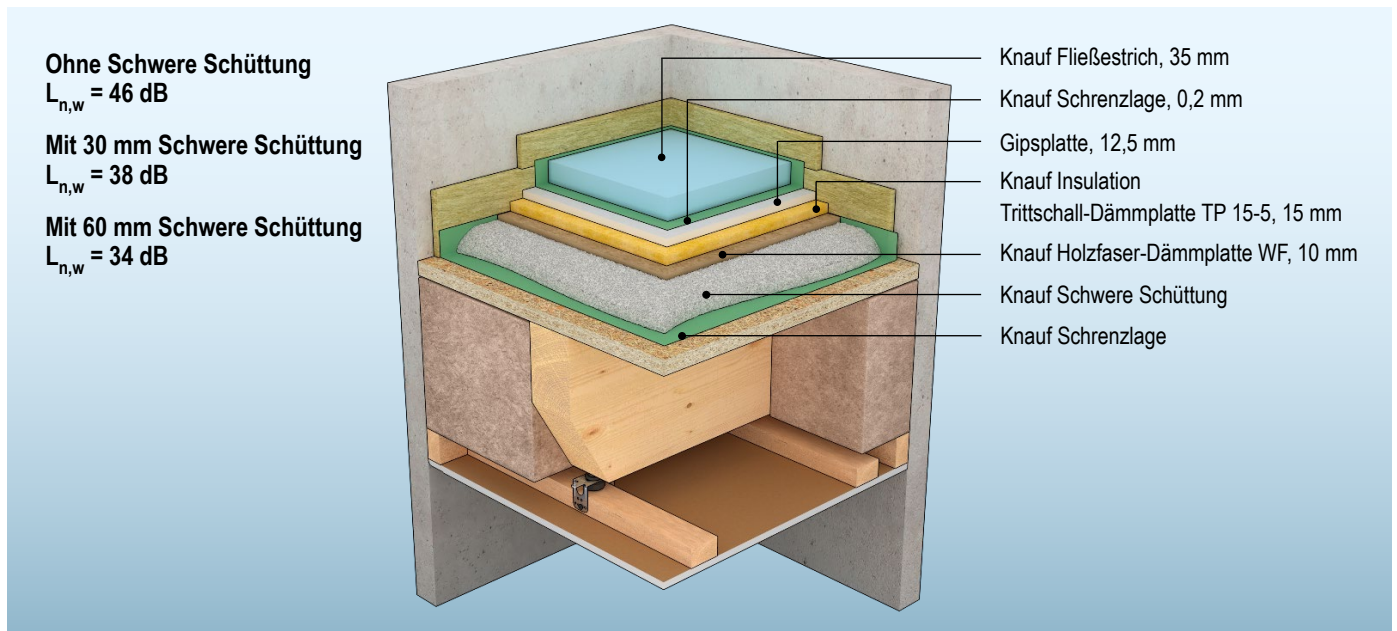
Fließestrich auf 12,5 mm Gipsplatte, 15 mm Trittschall-Dämmplatte TP 15-5, 10 mm Holzfaserdämmplatte WF und Schwere Schüttung
